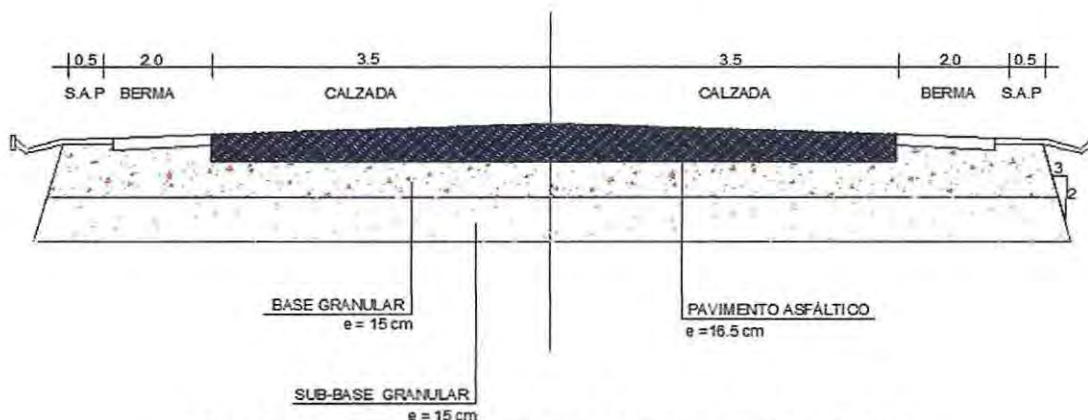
Esquema de la estructura de pavimento flexible, caso N°1
